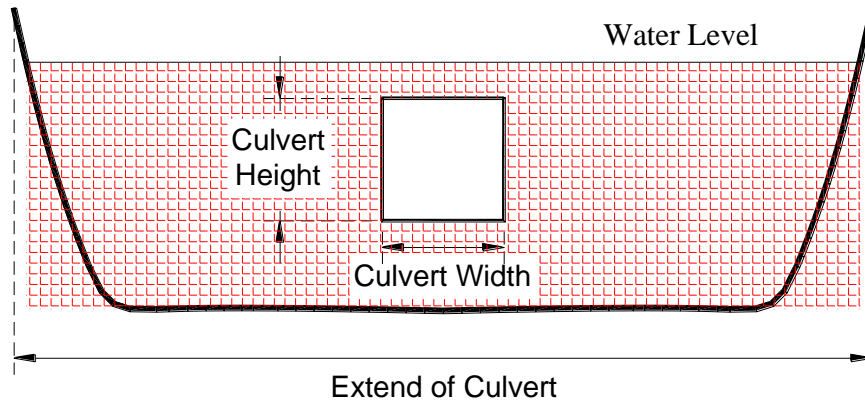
Definición de la geometría de la sección transversal de las alcantarillas
